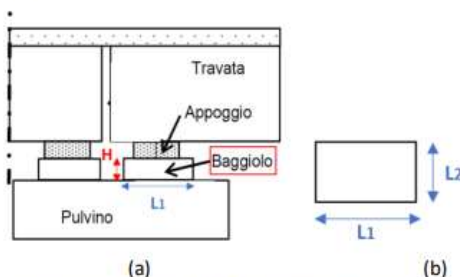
Baggioli: a) vista frontale; b) vista in pianta
